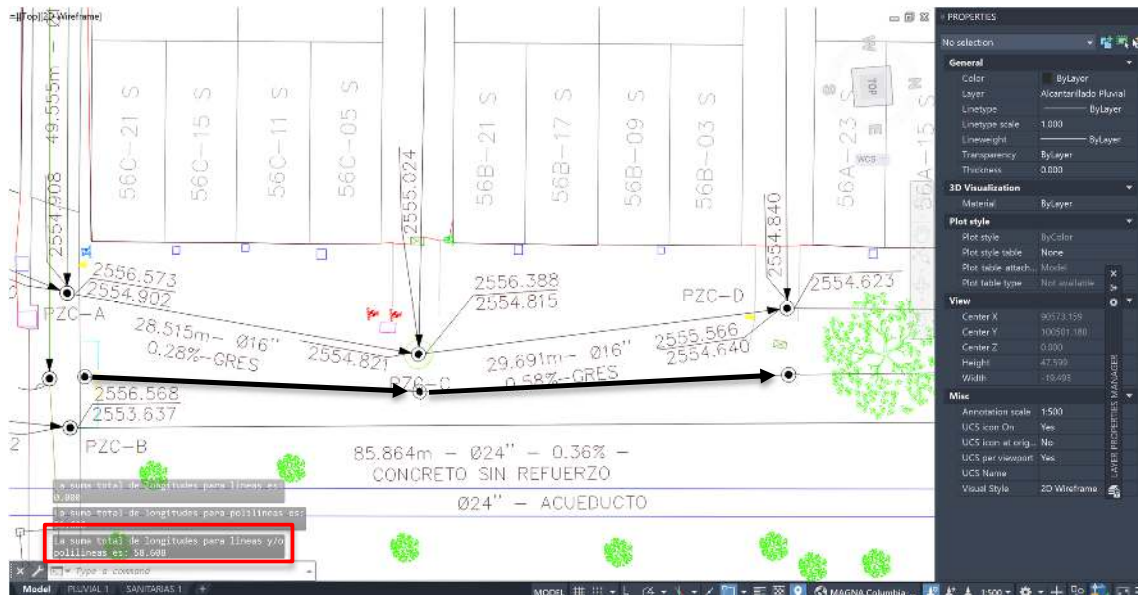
Cuantificación de longitud alcantarillado pluvial D400mm.
